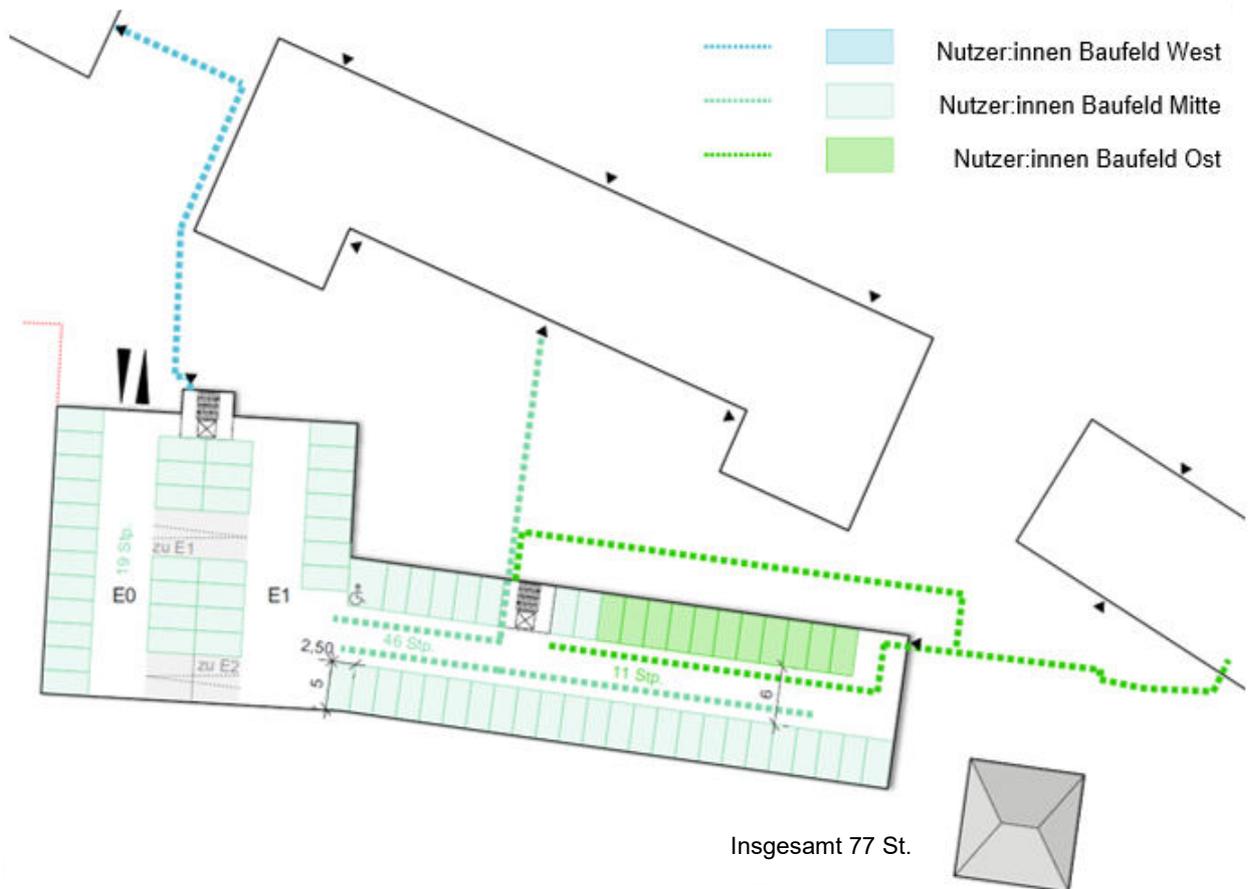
Funktionsgrundriss Parkhaus Ebene E0-E1 (o.M.)
